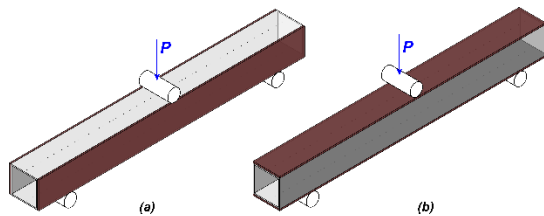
Refuerzos en toda la longitud del espécimen, (a) refuerzos en las almas; (b) refuerzos en las alas. Adaptado de: [10]
